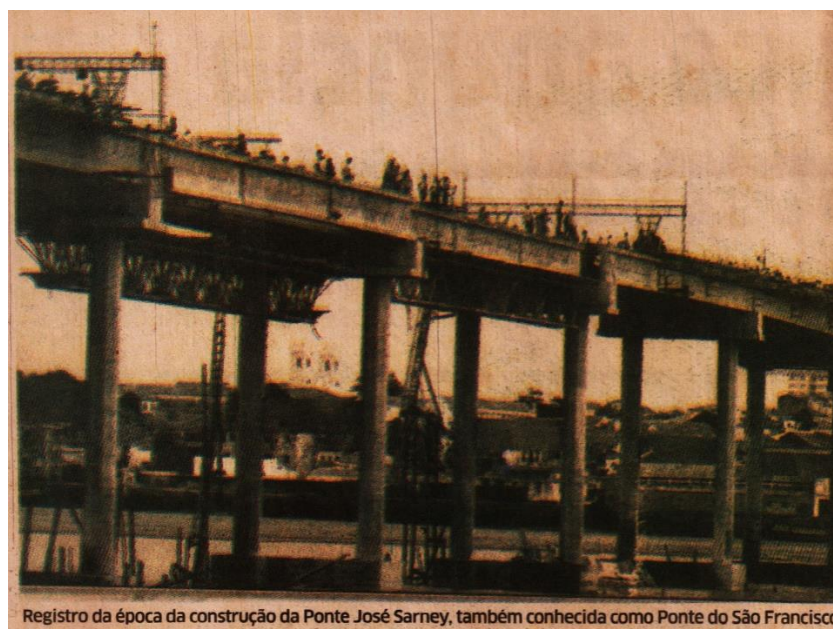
Construção da Ponte São Francisco. Jornal O Estado do Maranhão – Fevereiro/2013.
